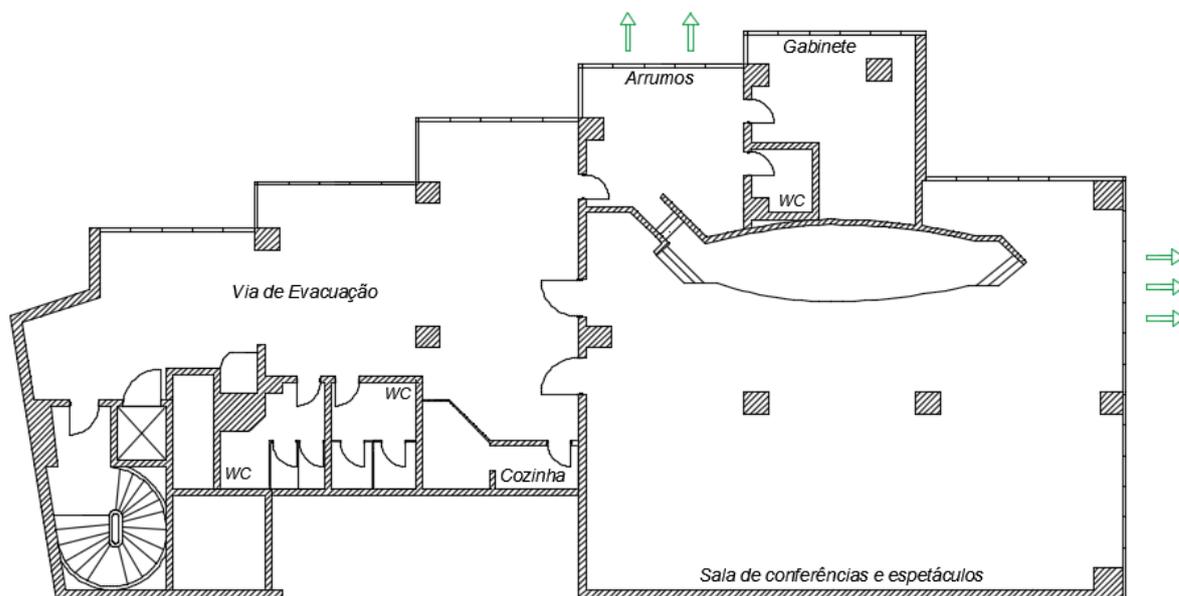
Planta do 2º Piso - Pontos de evacuação/penetração através de janelas
